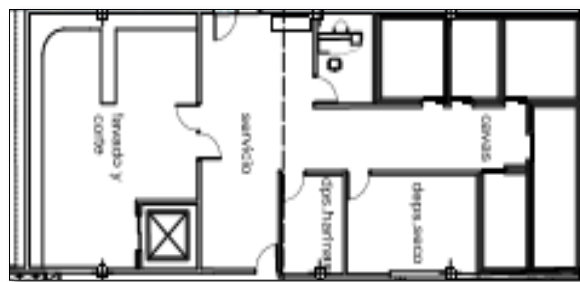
Servicio cafetín planta baja edificio ME-1. (2017)
